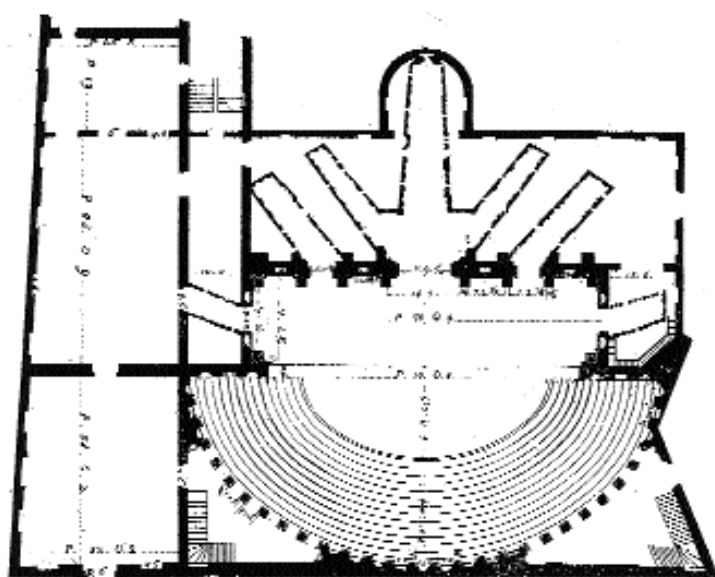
Le Teatro Olimpico d'A. PALLADIO. Plan d'après une édition de 1796.
